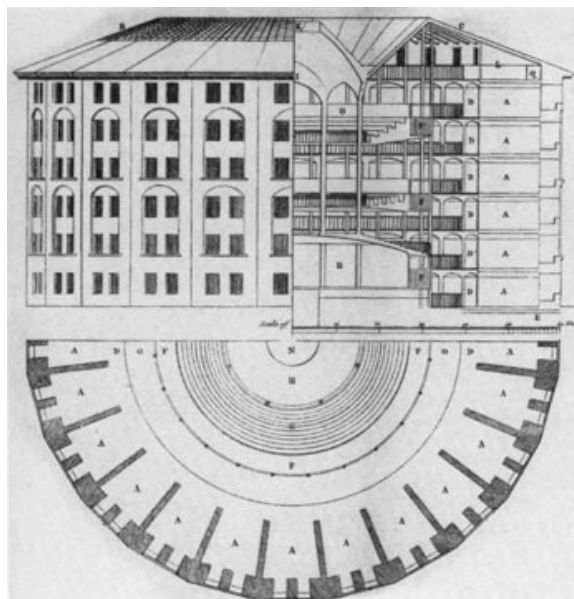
Corte vertical/alçado e planta parcial do modelo de prisão panóptica desenhado por Jeremy Bentham em 1791 (Foucault, 2010)
